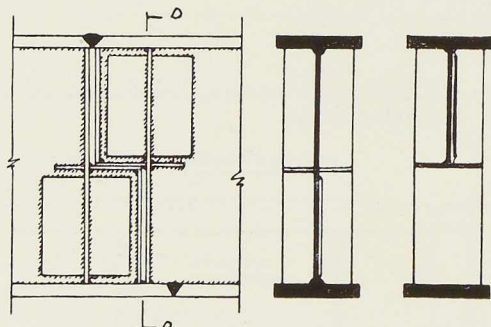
Assemblage de deux tronçons d'une poutre continue.
